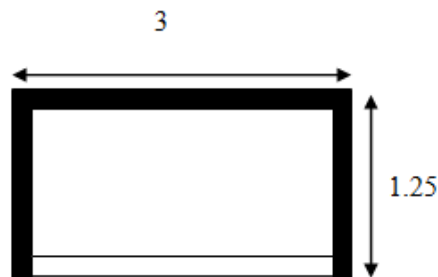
Schéma de ferrailage de la dalle pleine type1.
